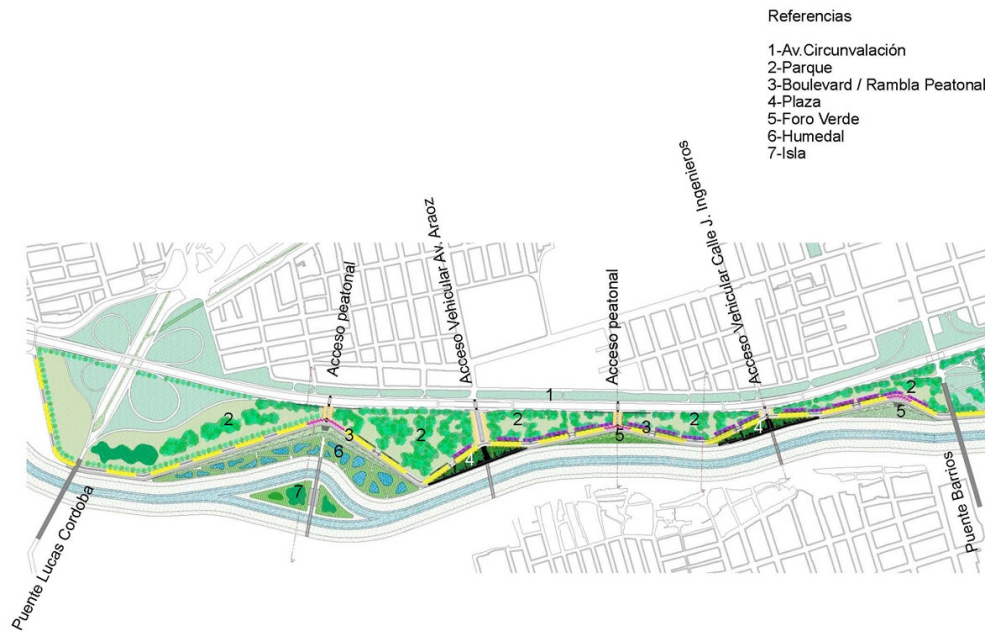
Planta del sector 4. Fuente: PROYECTO CCB
